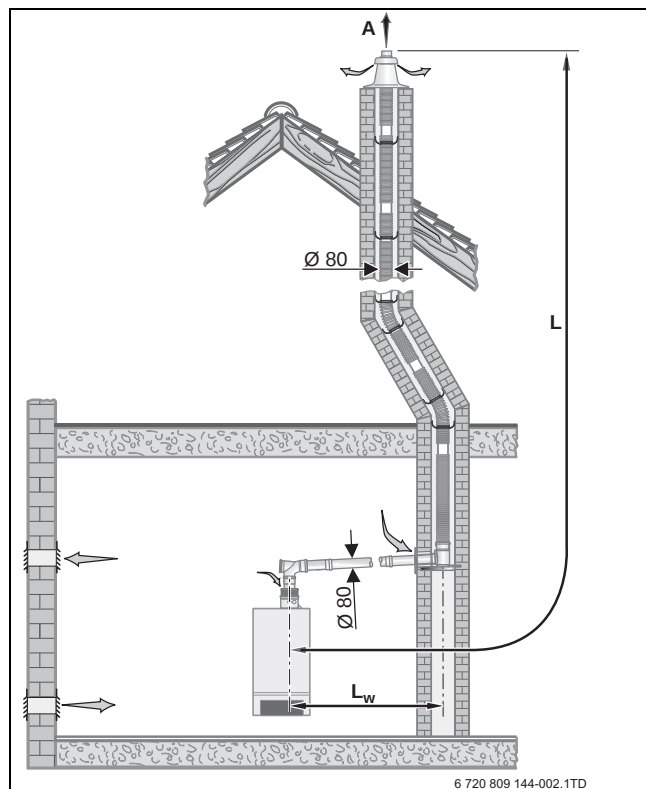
Montagevariante mit dem Bausatz GA + UB-Flex
